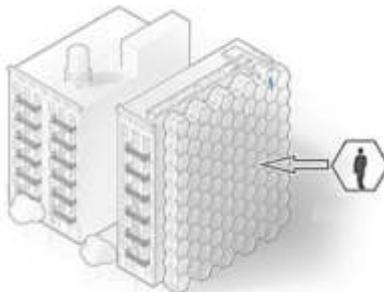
Схема расположения жилых капсул на фасаде здания
